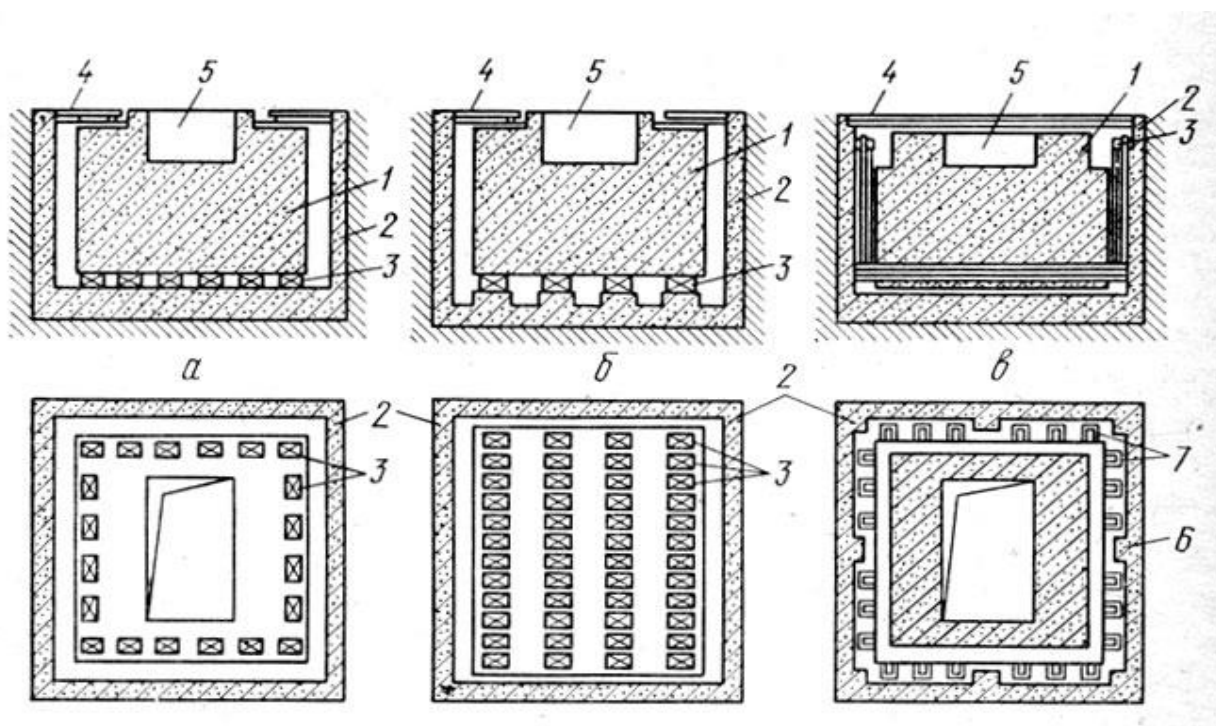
Схемы виброизоляции молотов: а, б – опорный вариант; в – подвесной вариант; 1 – фундаментный блок; 2 – подфундаментный короб; 3 – виброизоляторы; 4 – настил; 5 – подшаботная выемка; 6 – пилястры; 7 – подвесные стержни
